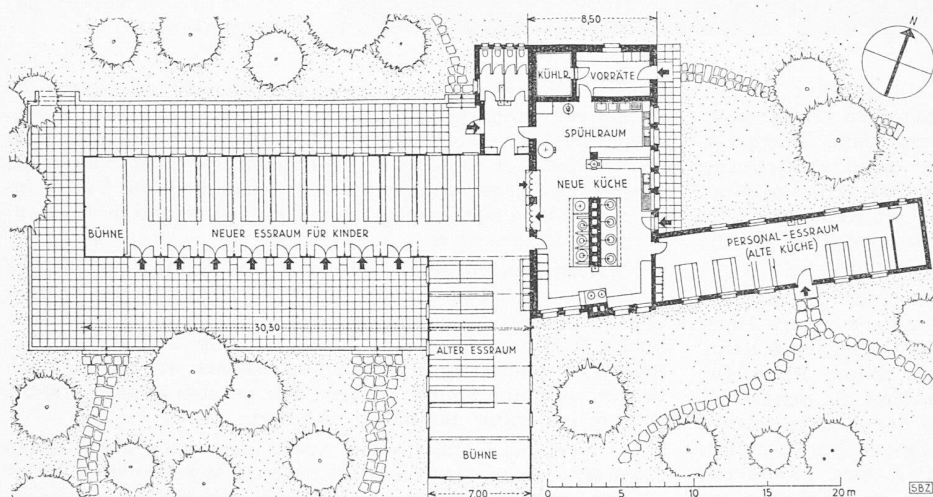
Die Küche mit den verschiedenen Essräumen, Grundriss 1:500
